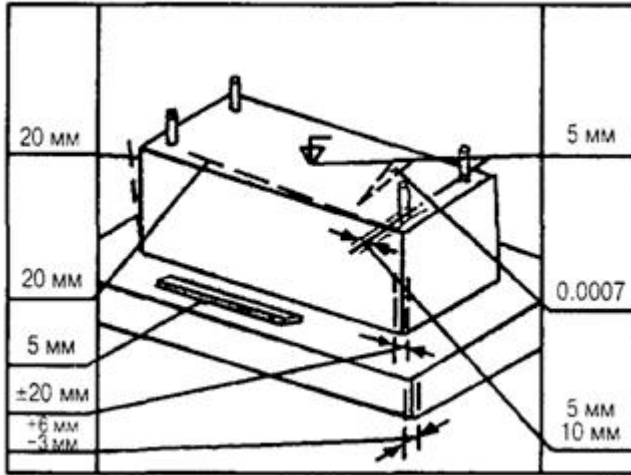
Допустимі відхилення при влаштуванні монолітних бетонних і залізобетонних фундаментів
